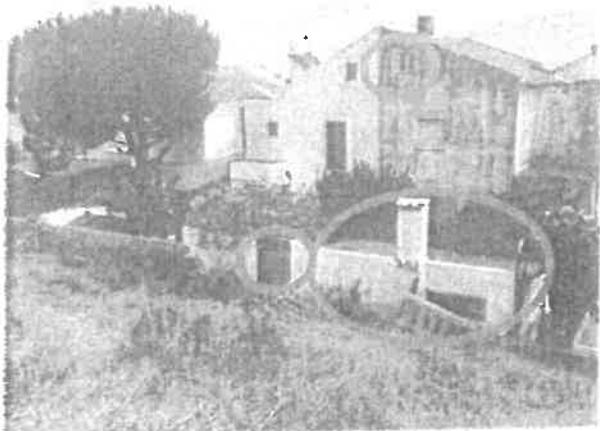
Vão de porta para lote privado, anexo e vão de janela e vão de janela para lote privado.
